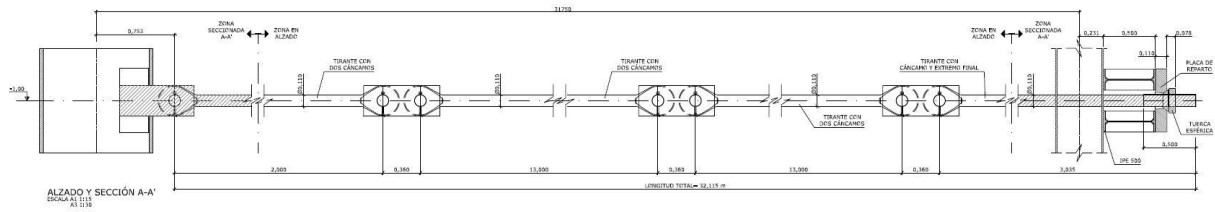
Alzado de los tirantes de la Sección tipo 2
